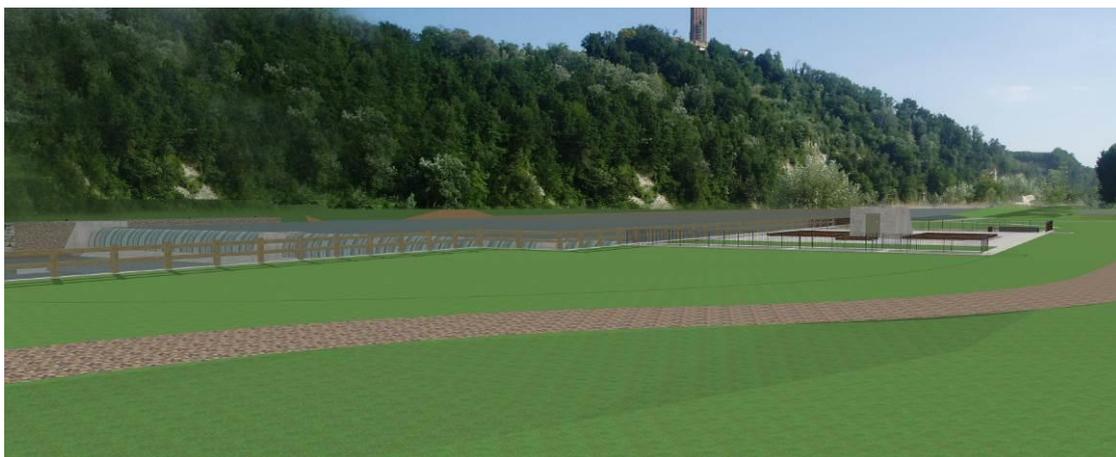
vista dell'area di accesso all'impianto presso la sponda sinistra del Fiume Tanaro con sullo sfondo la collina di Barbaresco.
